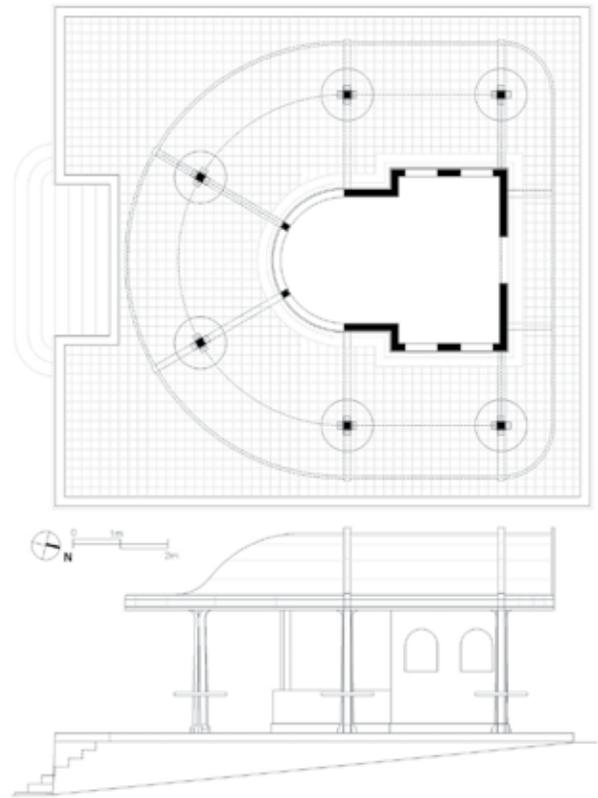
Plano del levantamiento arquitectónico, 2014. Archivo Alejandro Leal.
